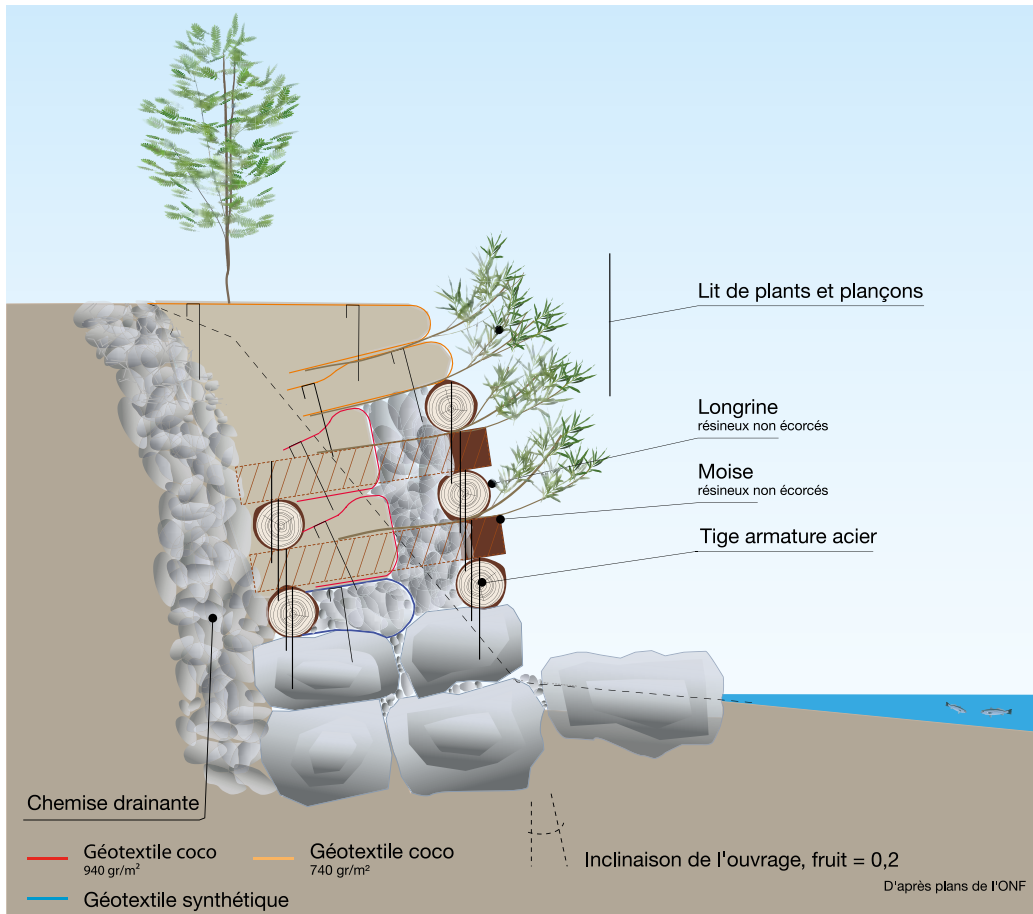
Coupe transversale de principe du caisson doubles parois végétalisé.
